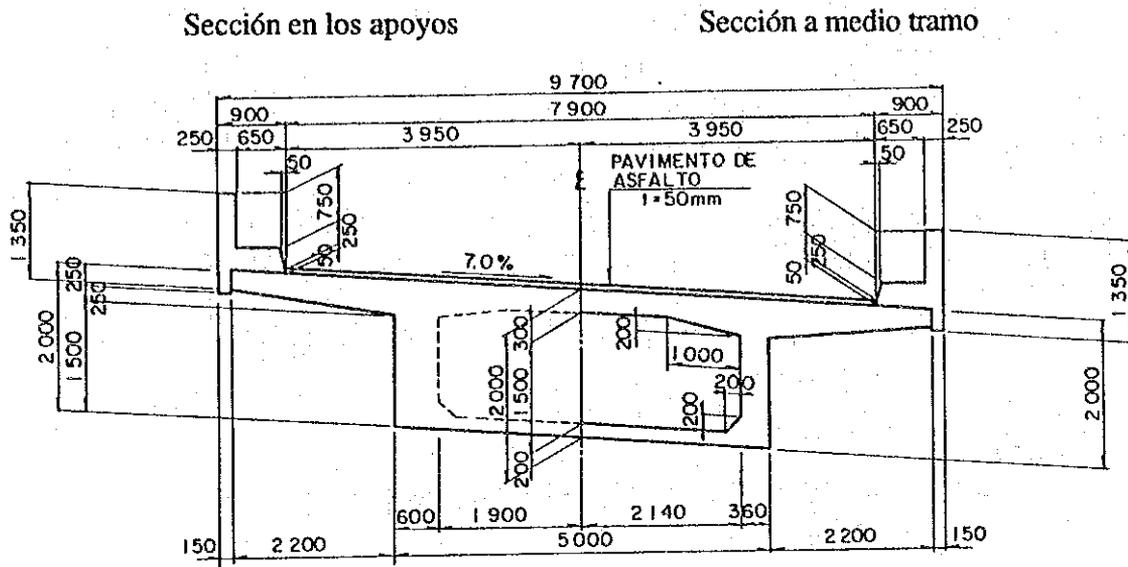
Sección de la viga curva tipo cajón de concreto postensado
